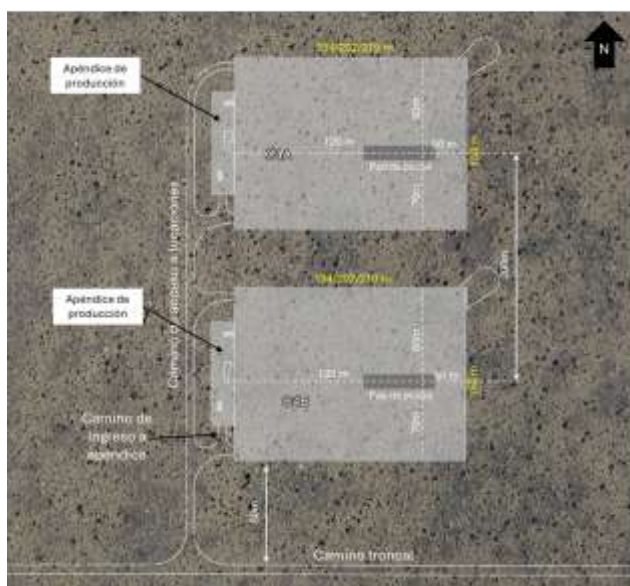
Esquemas tipo de locaciones proyectadas en BIN C. Construcción por etapas de perforación.
